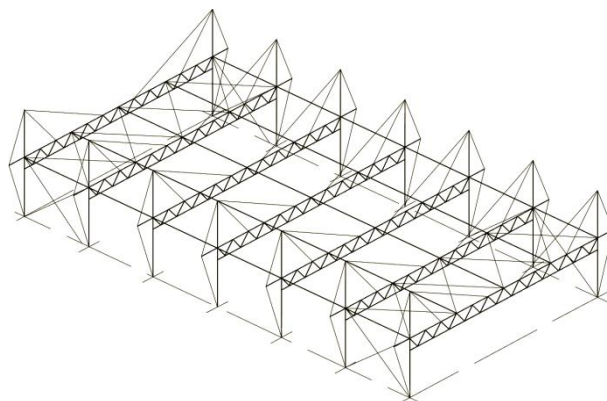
Esquema 3D de um pavilhão com pórticos treliçados (Best practice, 2008)
